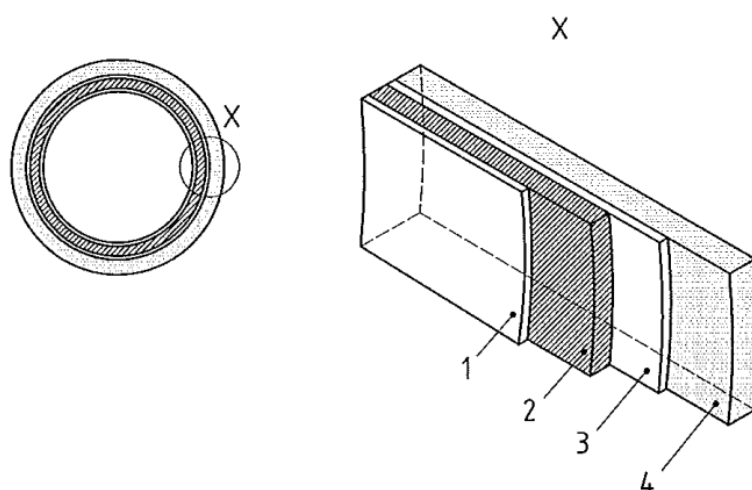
TIPICA COSTRUZIONE DELLA PARETE DEL LINER
